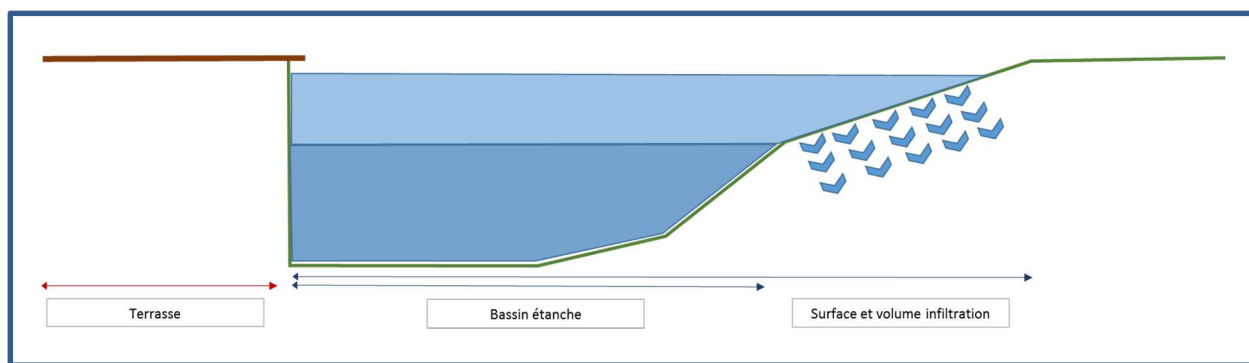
Schéma de principe – profil du bassin paysager de rétention / infiltration des eaux pluviales de toiture du bâtiment à construire et de l'aménagement terrasse attenante
